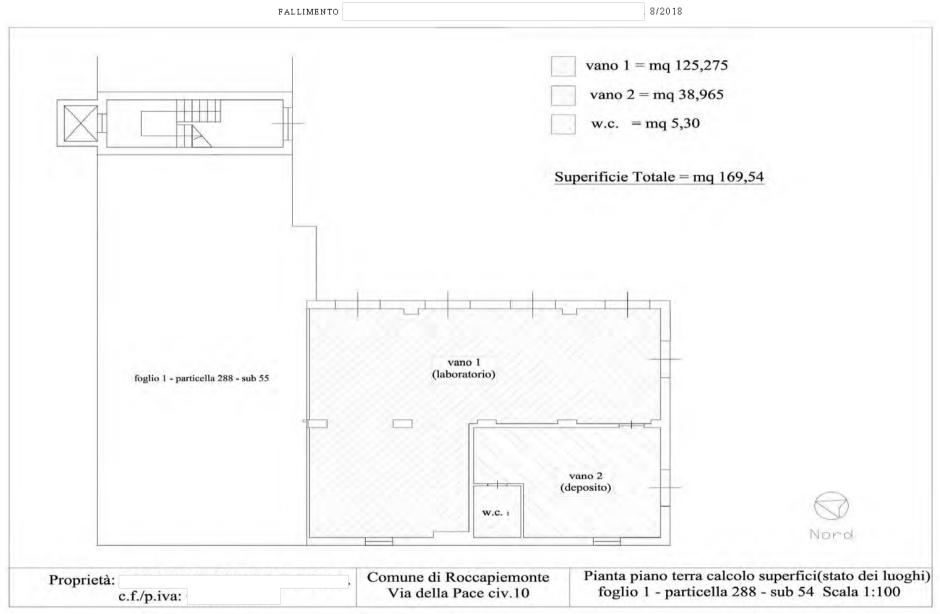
rappresentazione planimetrica con calcolo superficie locale commerciale fgl.1 p.lla 488 sub 54
